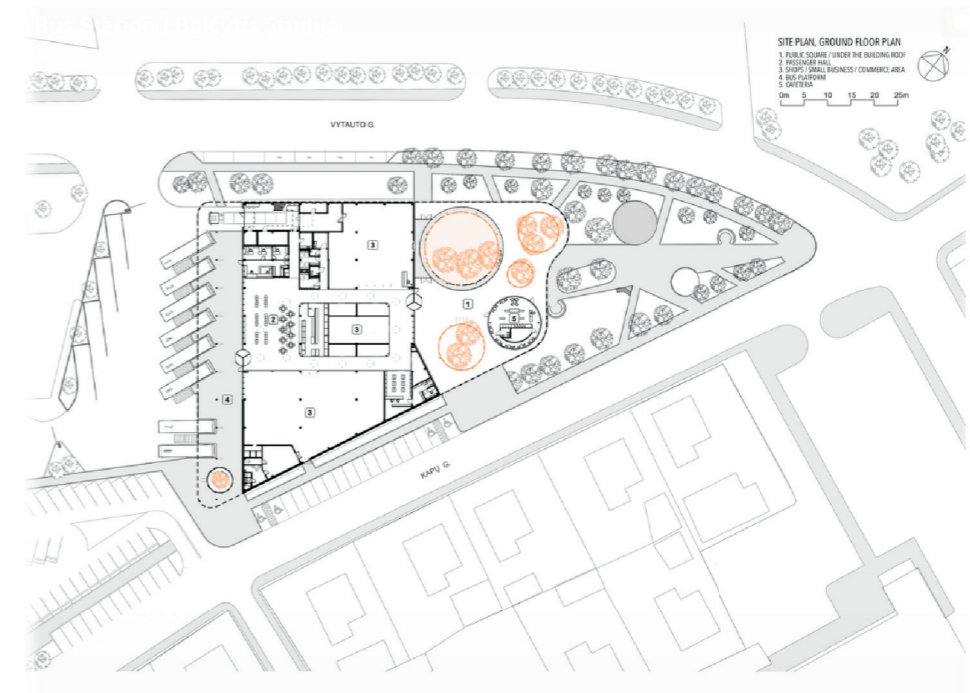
Planta baja de Vilkauskis Bus Station (Balcytis Studija).
